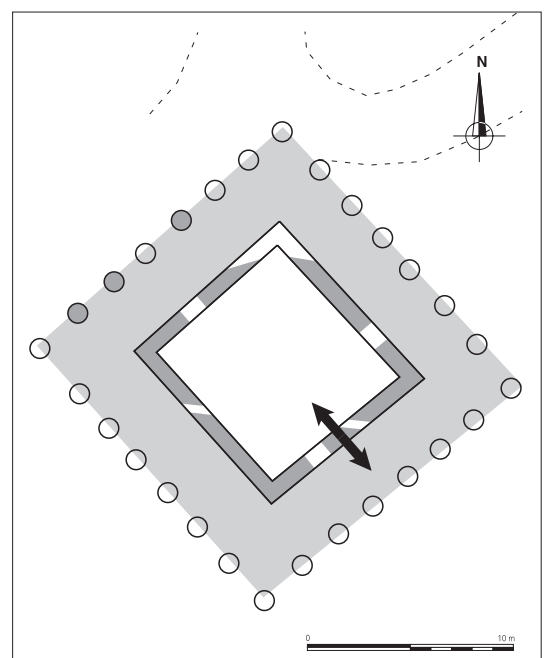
Fouilles de Bulet, Chasseron. Plan restitué du temple, état juillet 2005. (T. Luginbühl, J. Bernal - IASA)
